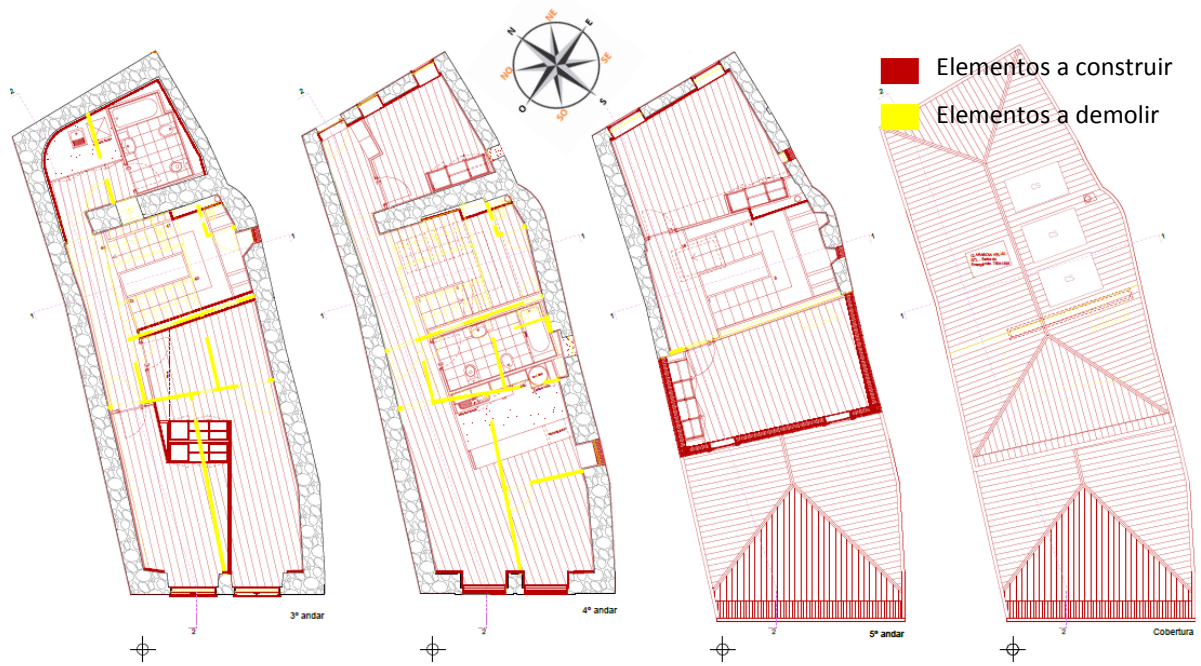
Plantas do 3º piso, 4º piso, 5º piso e cobertura [17]
